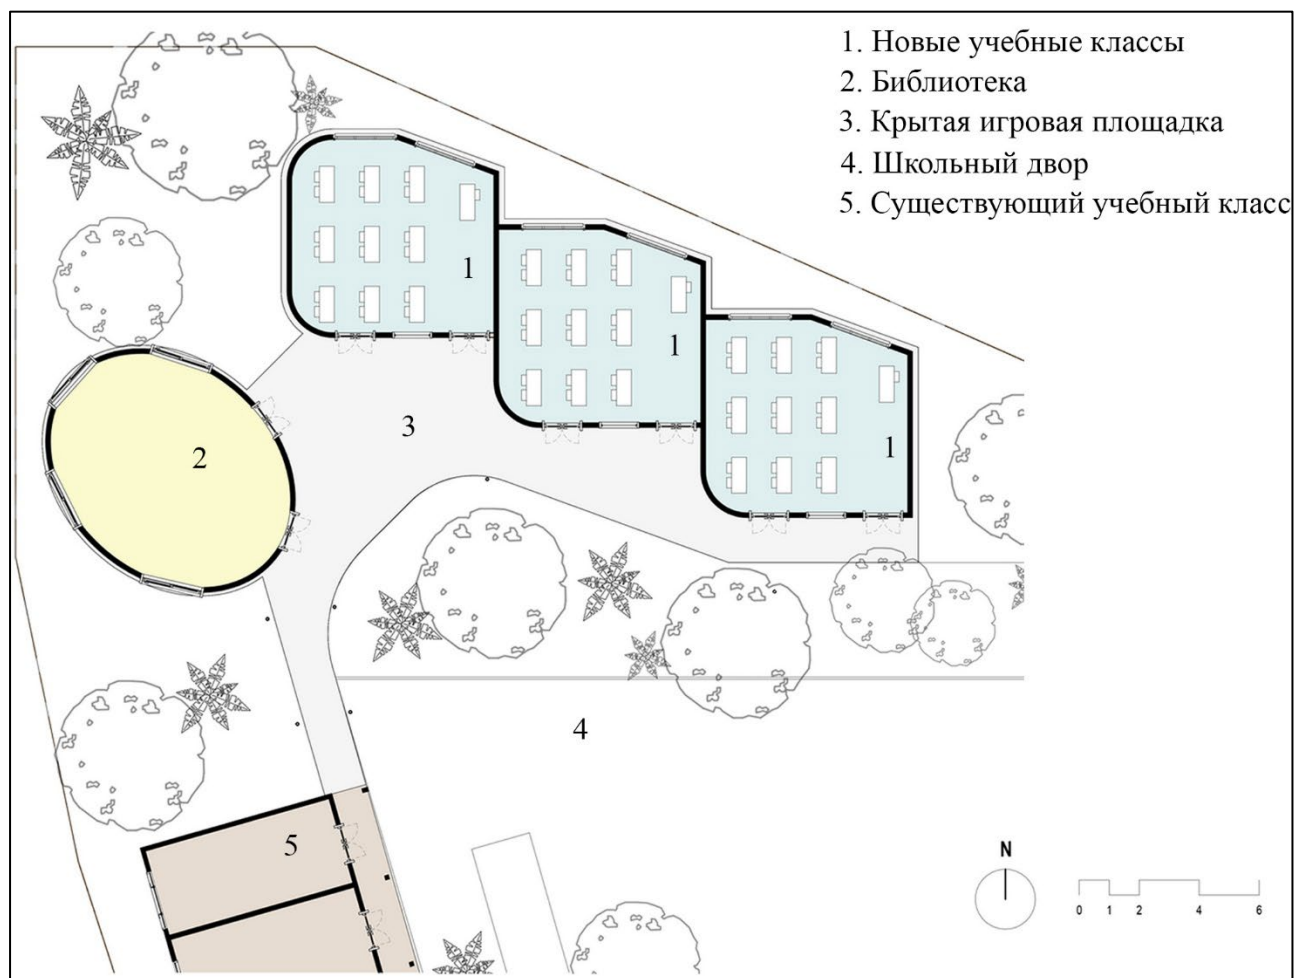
План первого этажа школы На Бан. [43]
